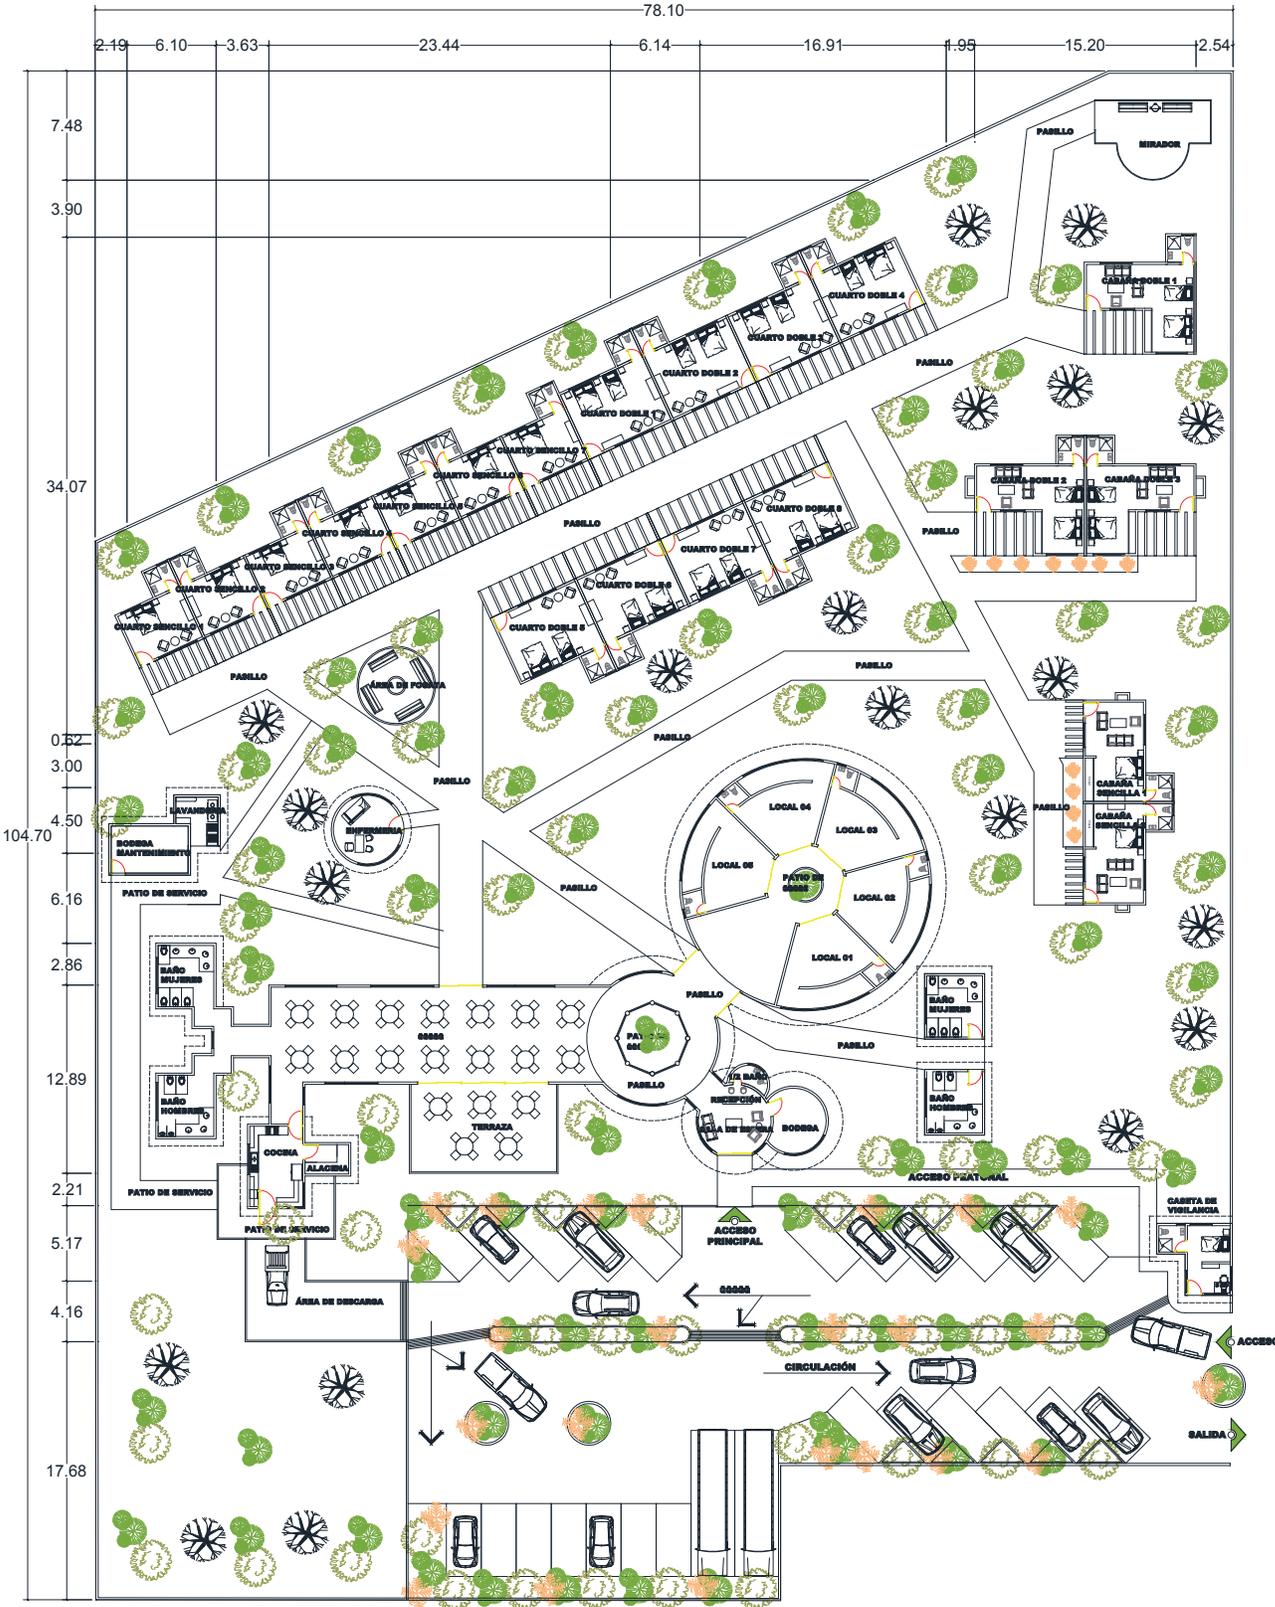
| Planta arquitectónica del anteproyecto 1.
